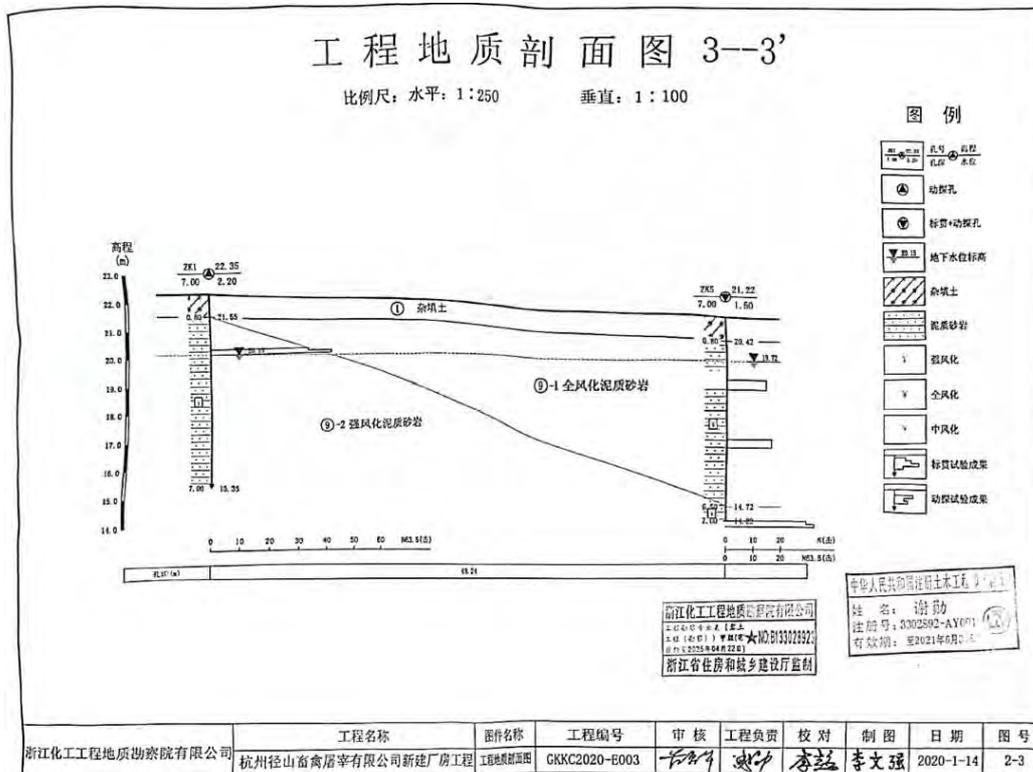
工程地质剖面图 (ZK1~ZK5 剖面)
